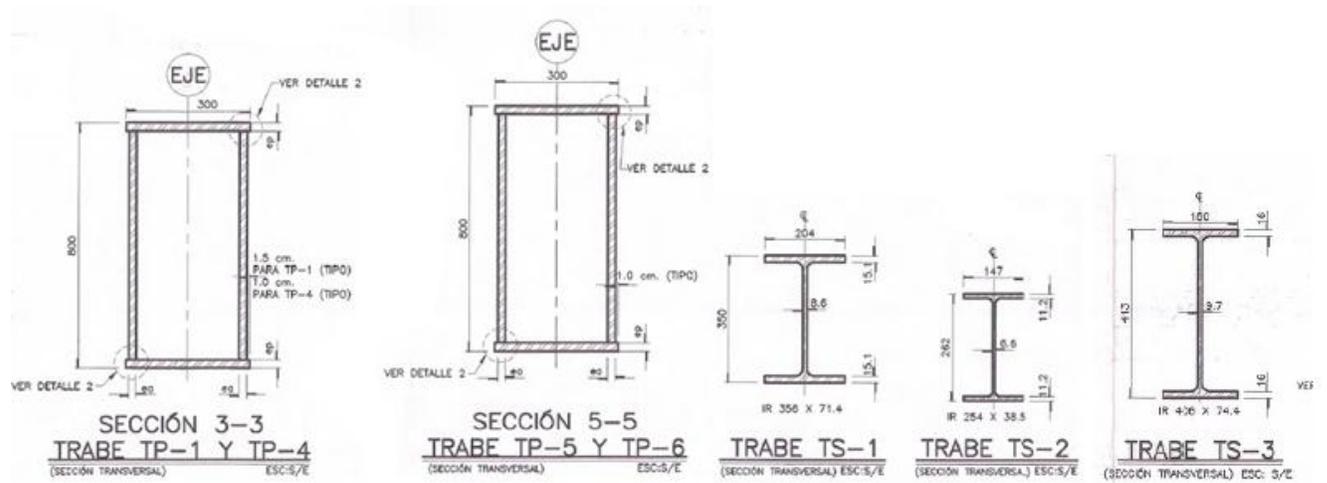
Sección traveses tipo cajón longitudinales y transversales principales TP-1, TP-4, TP-5 y TP-5, traveses secundarias transversales perfil IR TS-1, Traveses TS-2 y TP-3.
